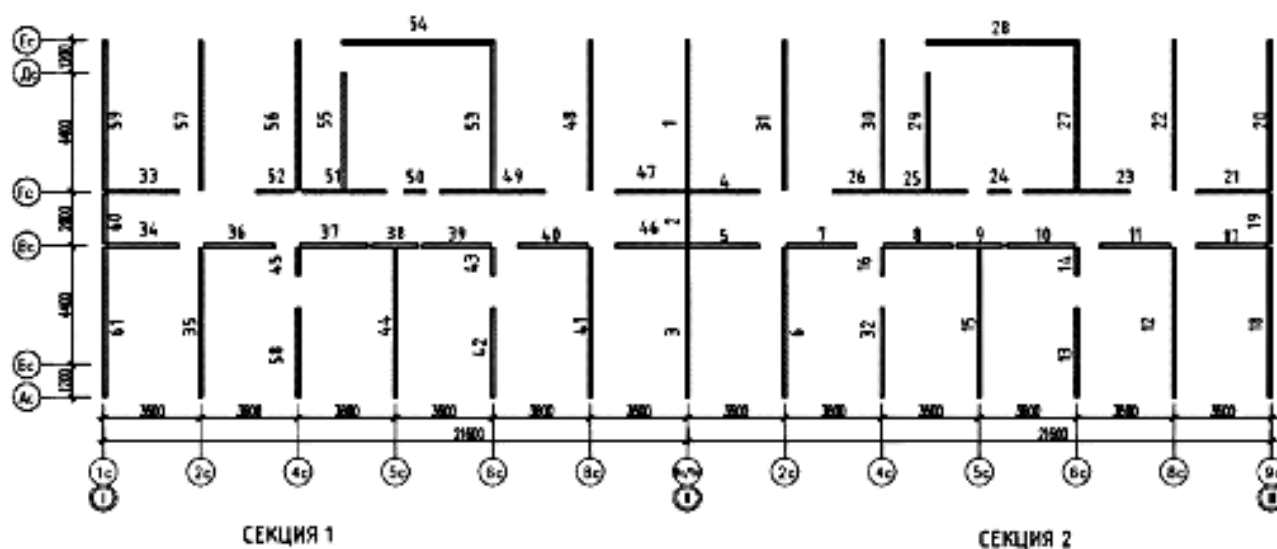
Номера простенков 2-го этажа жилого дома
